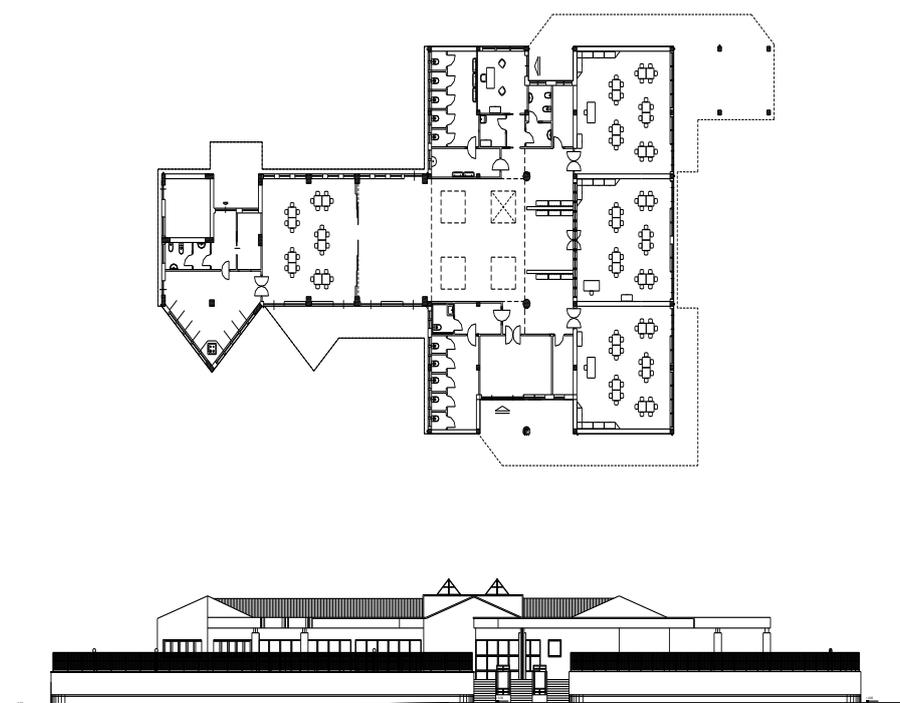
Planimetria e prospetto principale dell'edificio scolastico per l'infanzia "S. Francesco"
